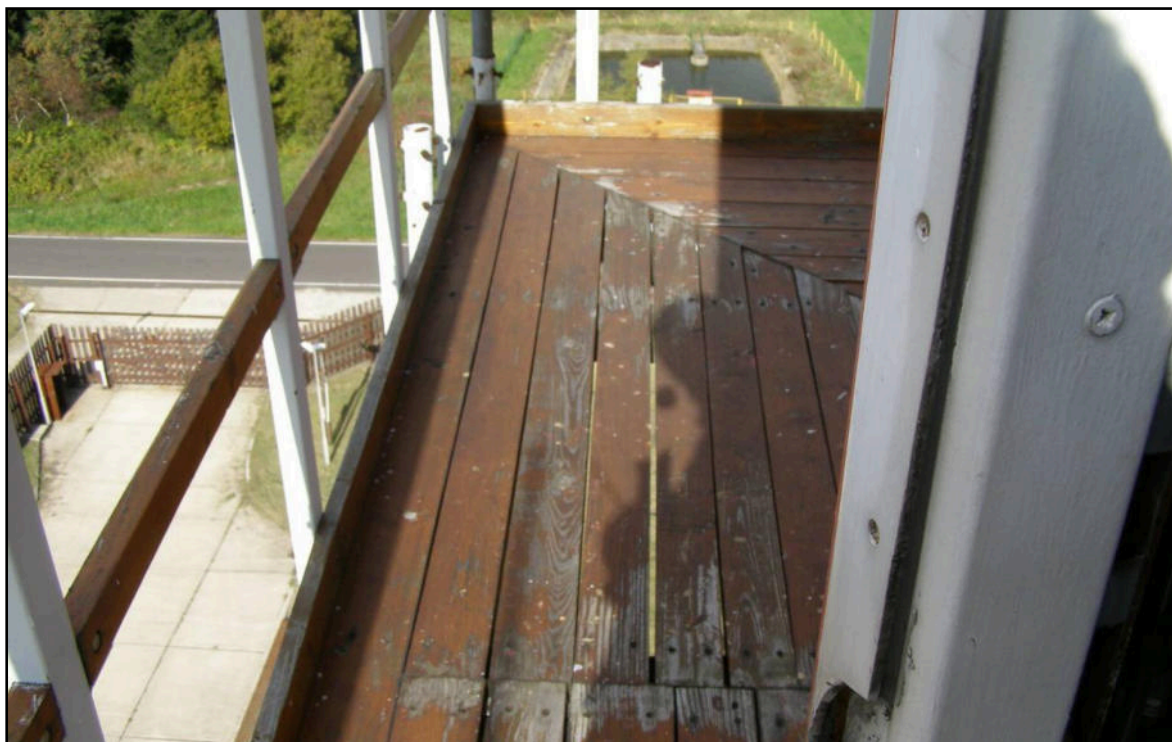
Anténní stožár s nástavbou – detail podlahy střední podesty (pohled na horní líc)
